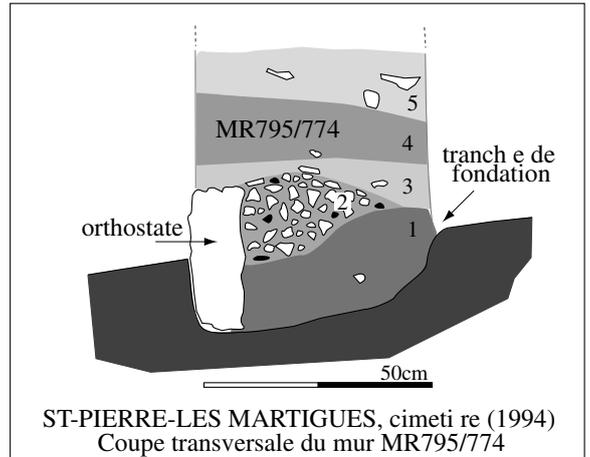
Saint-Pierre-les-Martigues, le Cimetière. Coupe transversale schématisée du mur MR795/774. L'orthostate installée dans la tranchée de fondation retient les couches 1 (terre) et 2 (cailloux et tessons). Par dessus, la terre est déposée en lits à peu près horizontaux mais composés de matériaux différents, comme le révèlent les photos des bermes du sondage (fig. 16 et 17).
